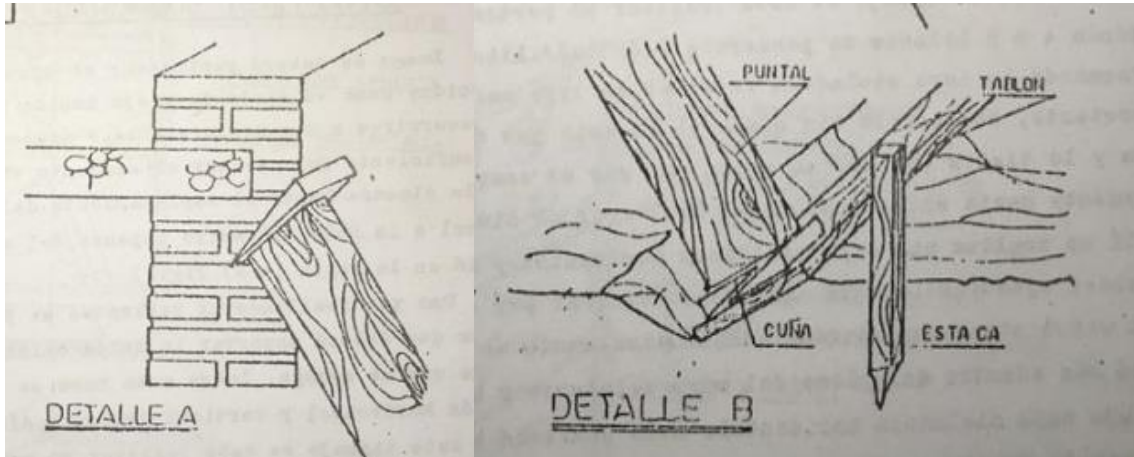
Detalles de apoyo de puntal con muro y suelo
